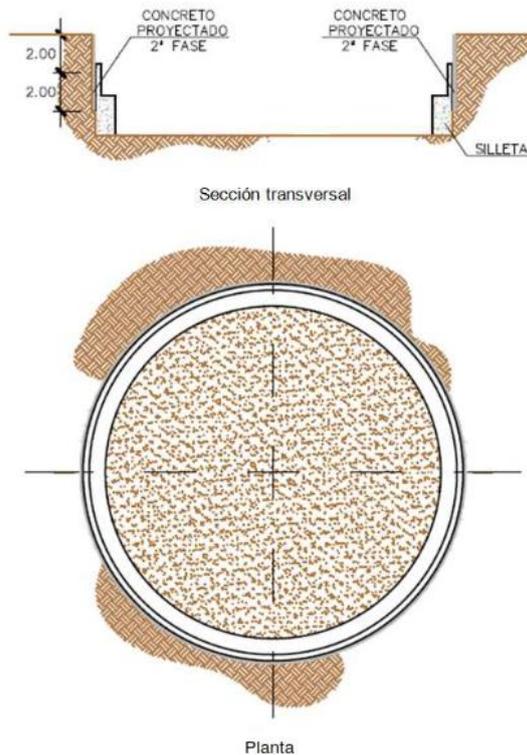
10 Sección transversal de planta y anillo 01
